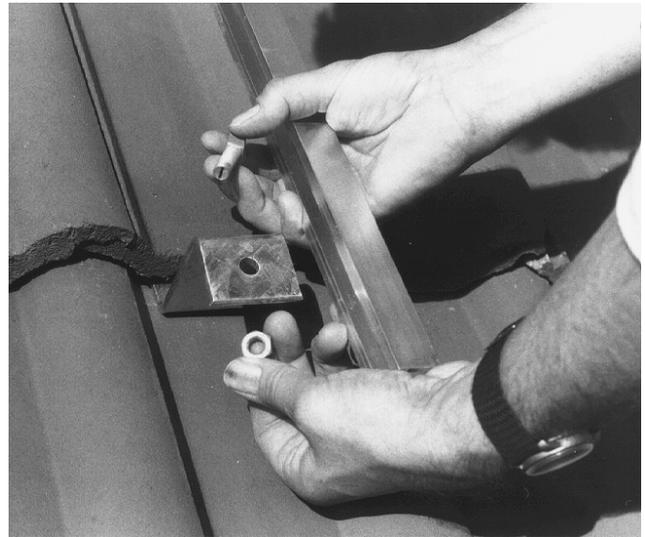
Eine sichere Dachverbindung mit Montageschiene, Hammerkopfschraube und Sparrenanker (hier Typ „P“ für Frankfurter Pfanne und ähnliche Formen).
